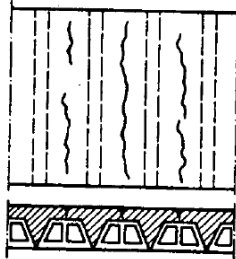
Fisuración del concreto por retracción plástica.
